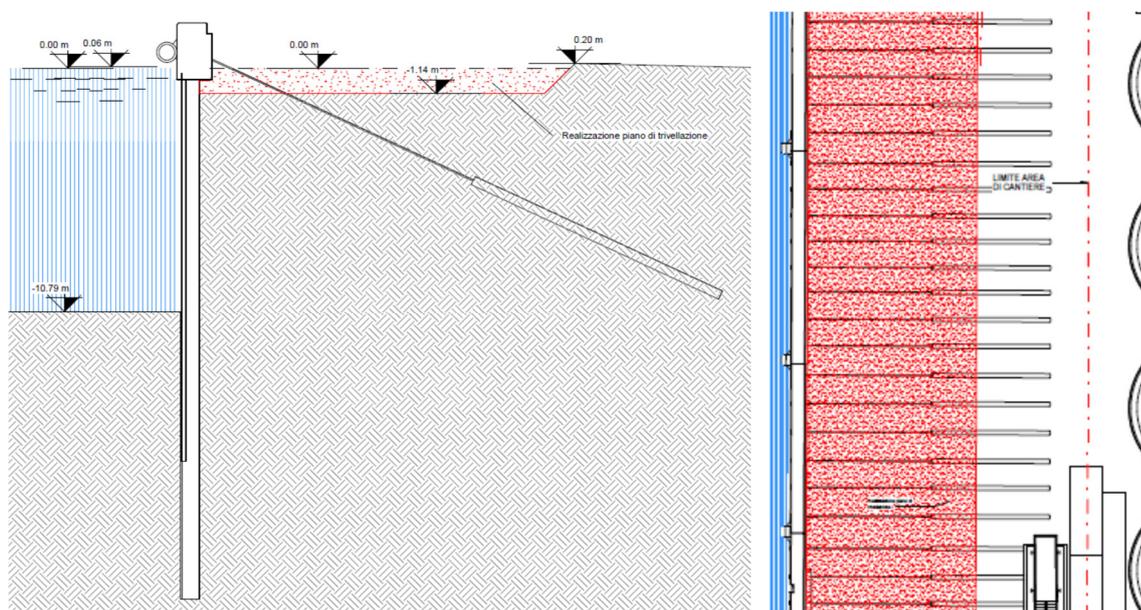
Banchina Bunge Sud – Fase 2 – Sezione e planimetria
